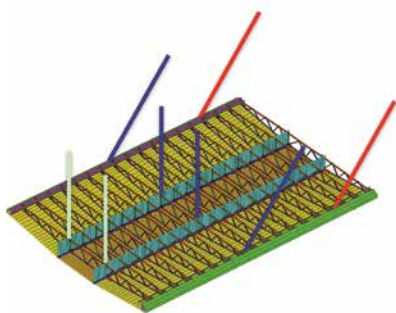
Illustration des trois modes de suspension du tablier – construction simultanée de la partie en encorbellement haubanée et de la pose des câbles principaux
